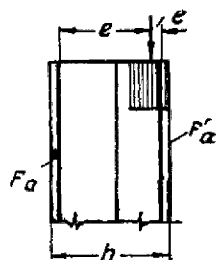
Внецентренное сжатие армированной кладки при больших эксцентриситетах.
